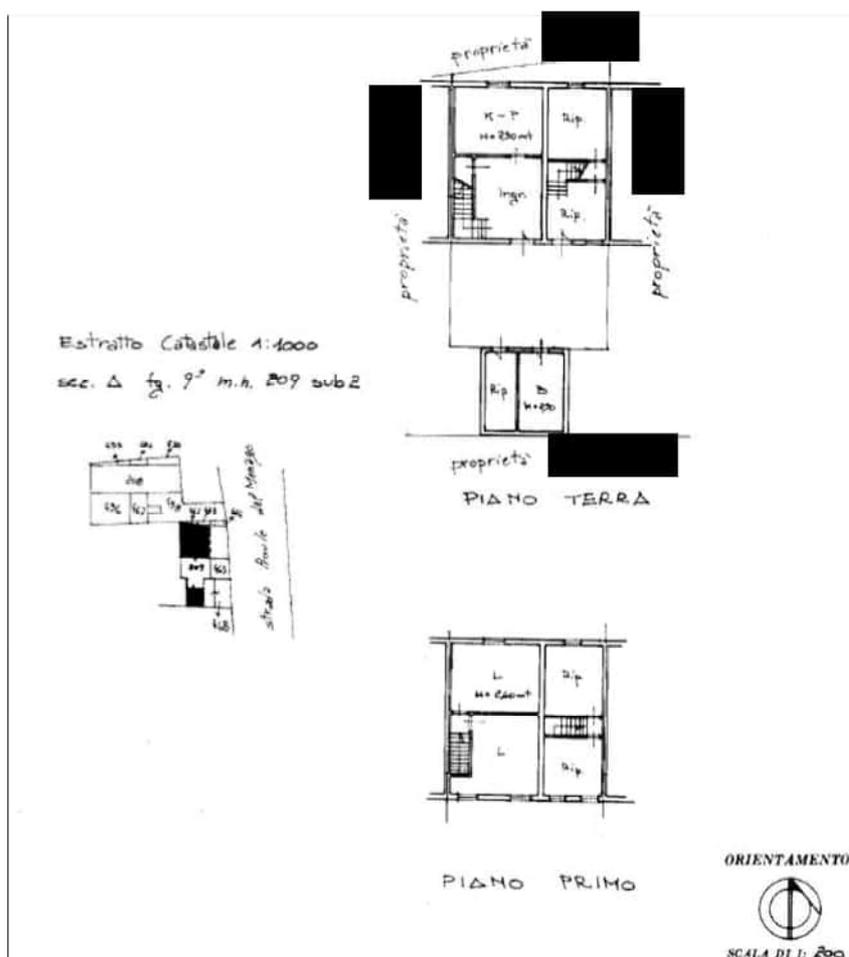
Planimetria catastale in atti, part. 209, sub. 2
